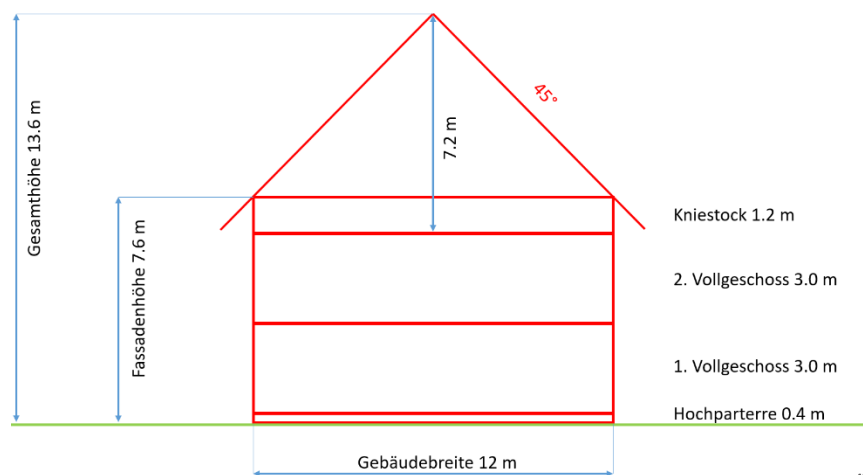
Schrägdachbau Dorfzone mit neuen Höhenmassen
